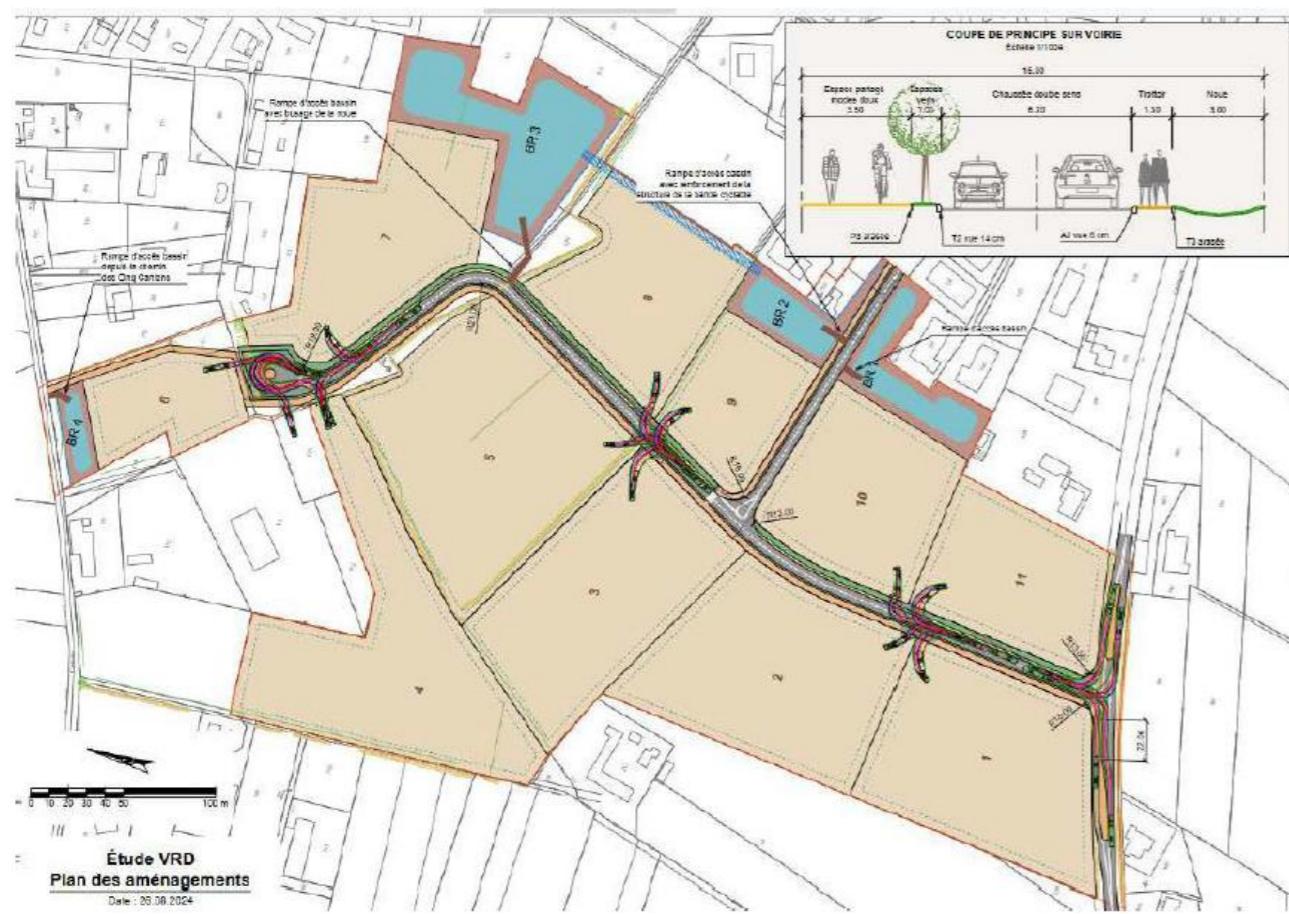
Implantation et spatialisation du projet (source : Cyclade)
